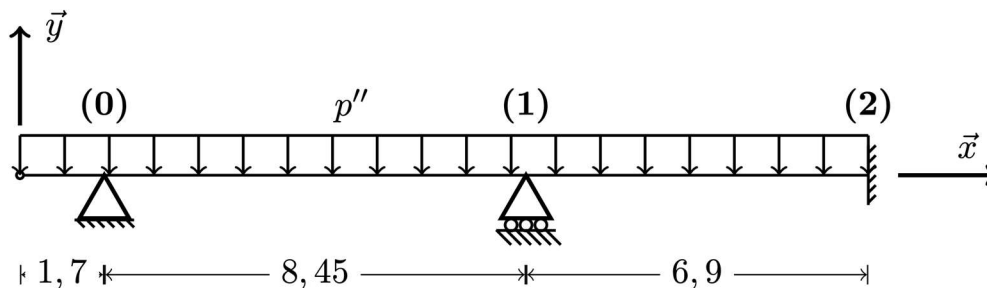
Modélisation retenue pour la poutre continue, plancher haut
